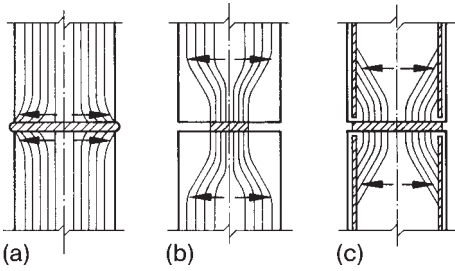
Lagerungsarten von Druckfugen; a) weichgebettete Fuge, Querspannungen infolge seitlichen Ausweichens des Fugenmaterials, b) hartgebettete eingeschnürte Fuge, Querspannungen infolge Einschnürung, c) hartgebettete vollflächige Fuge, Querspannungen infolge Umlenkung des Traganteils der Längsstäbe und des Betonmantels
